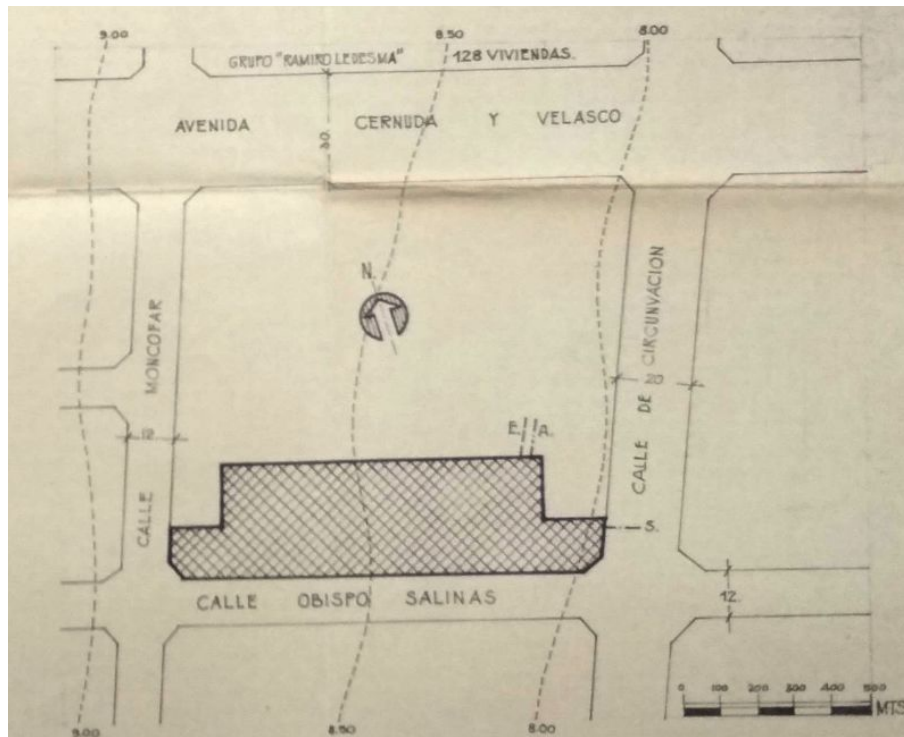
Plano emplazamiento proyecto (Fuente: Archivo Histórico Municipal de Castellón)
